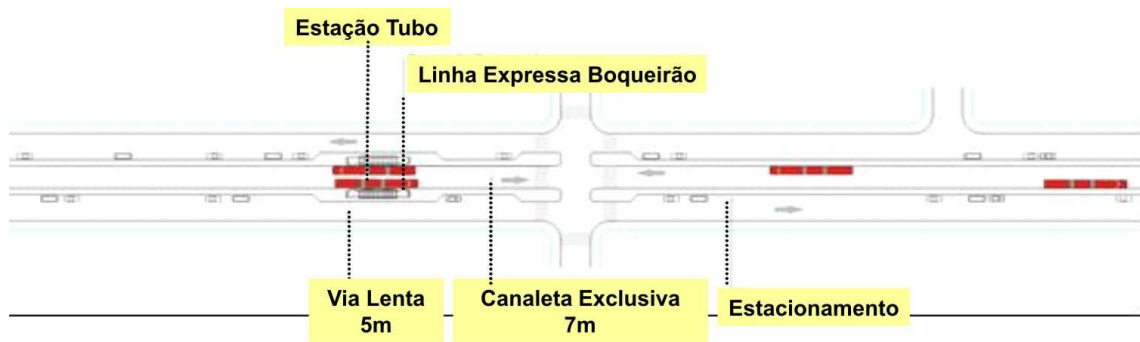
Esquema de ultrapassagem - canaleta eixo Boqueirão - situação atual
